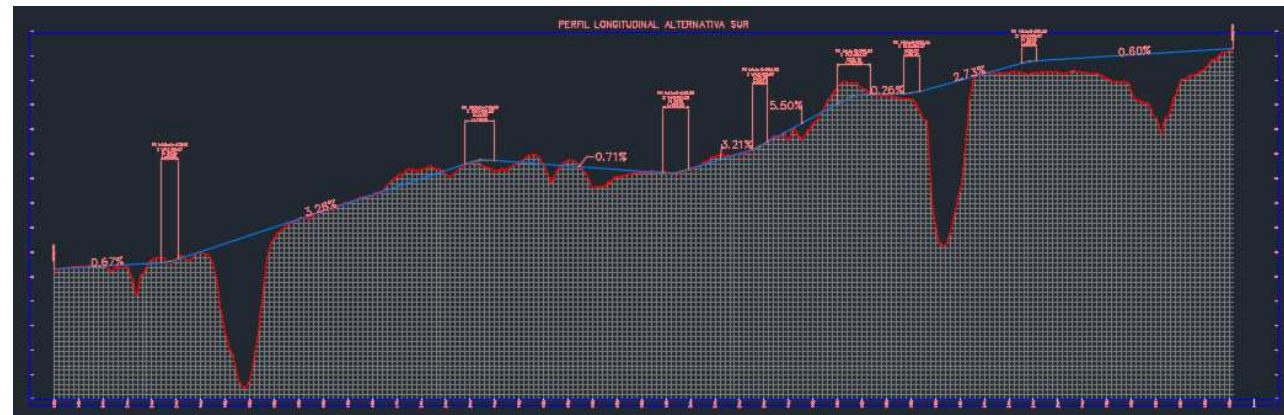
Perfil Longitudinal de la Alternativa Sur
